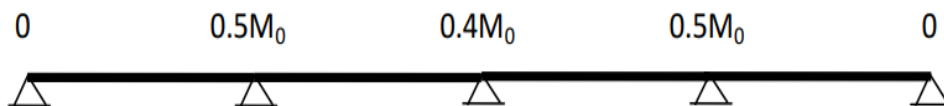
Schéma d'une poutrelle à plusieurs travées
